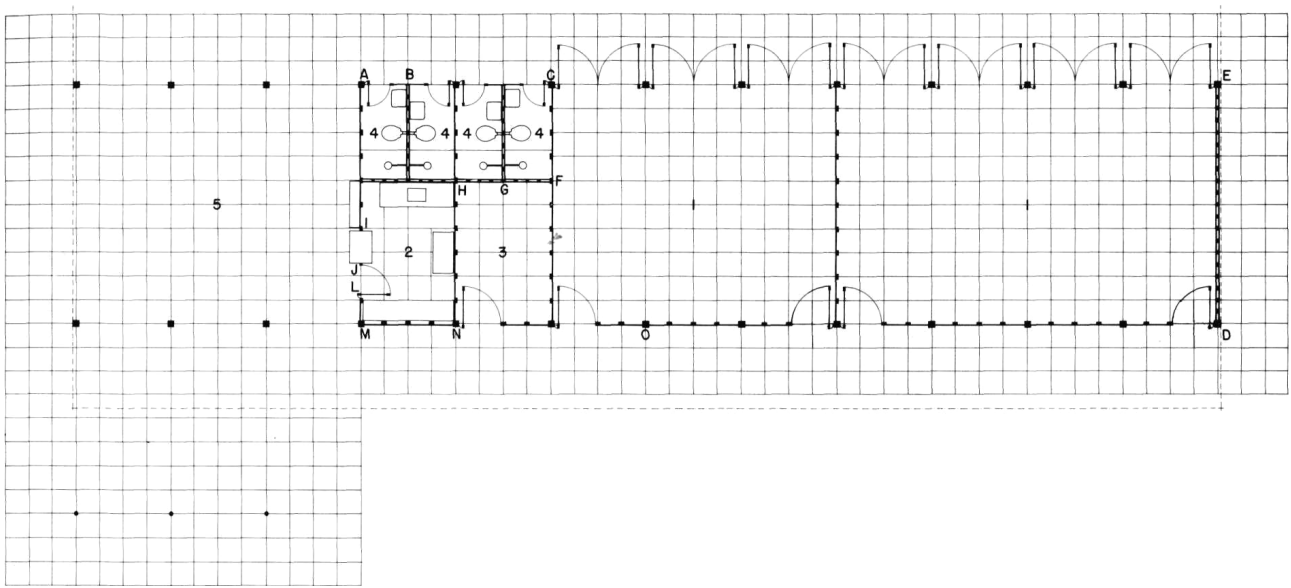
planta da escola construída, para 70 alunos. Fonte: LIMA, 1984.
